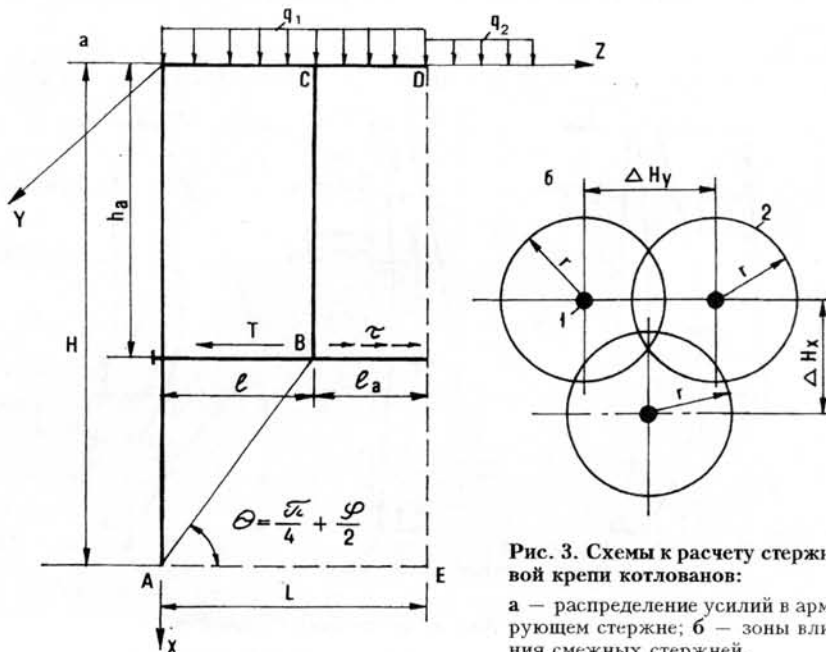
Схемы к расчету стержневой крепи котлованов:
